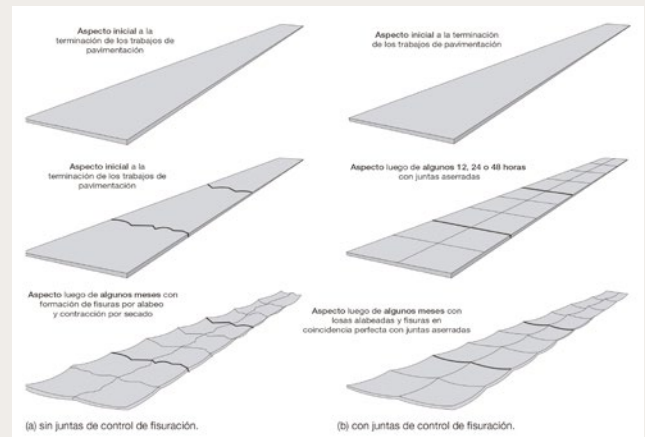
Patrón de fisuración básica en pavimentos de concreto Fuente: E. Becker, 2004. “Seminario sobre pavimentos de hormigón”
